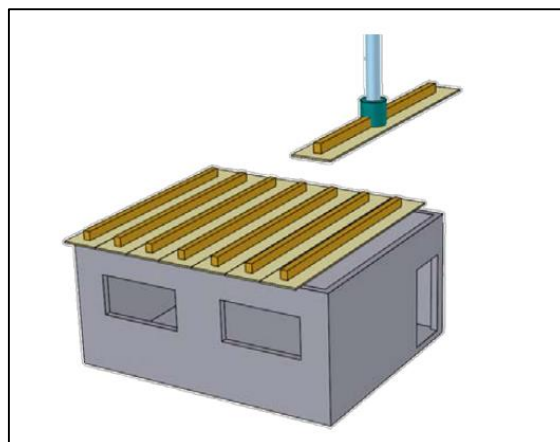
Colocación de las vigas sobre el edificio. Fuente: <http://cort.as/-M57g>
